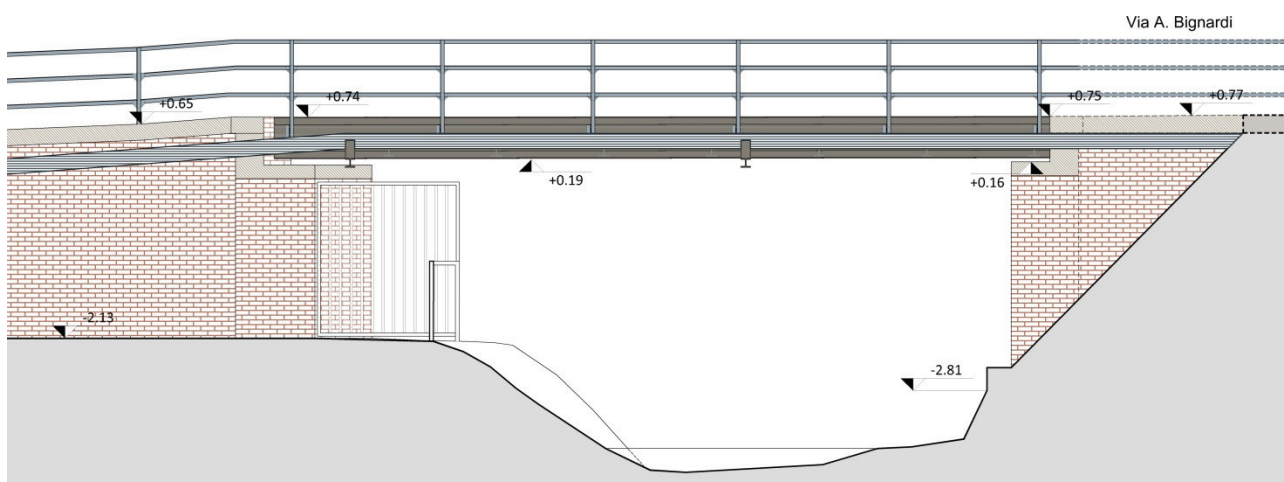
Prospetto sud, ponte in ferro – Come il fronte nord, la struttura è composta di elementi metallici appoggiati sulle selle delle spalle alle sue estremità. In questo tratto, le staffe che portano le tubazioni sono collegate alla trave di bordo mediante travi HEA120.
